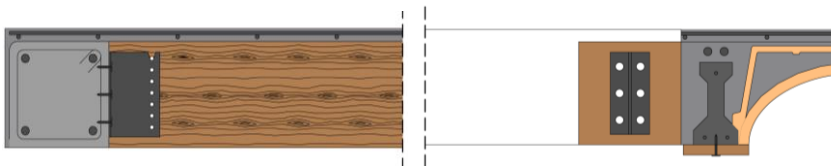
Detalle unión viga madera – Viga hormigón. 2024. Fuente: Propia
